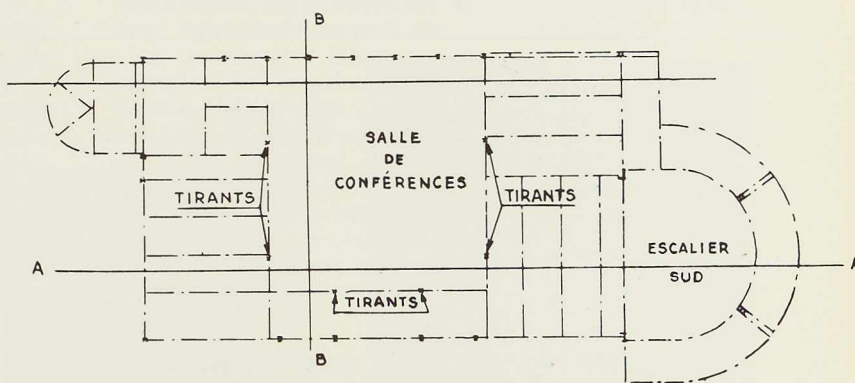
Plan de l'ossature métallique du hall au deuxième étage.
